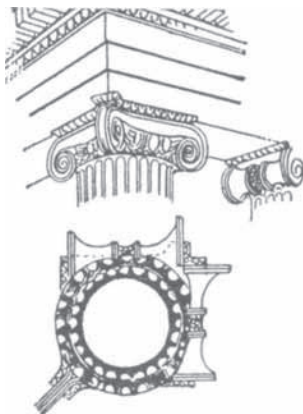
VISTA Y PLANTA DE UN CAPI-TEL JÓNICO CON VOLUTA DE ÁNGULO
